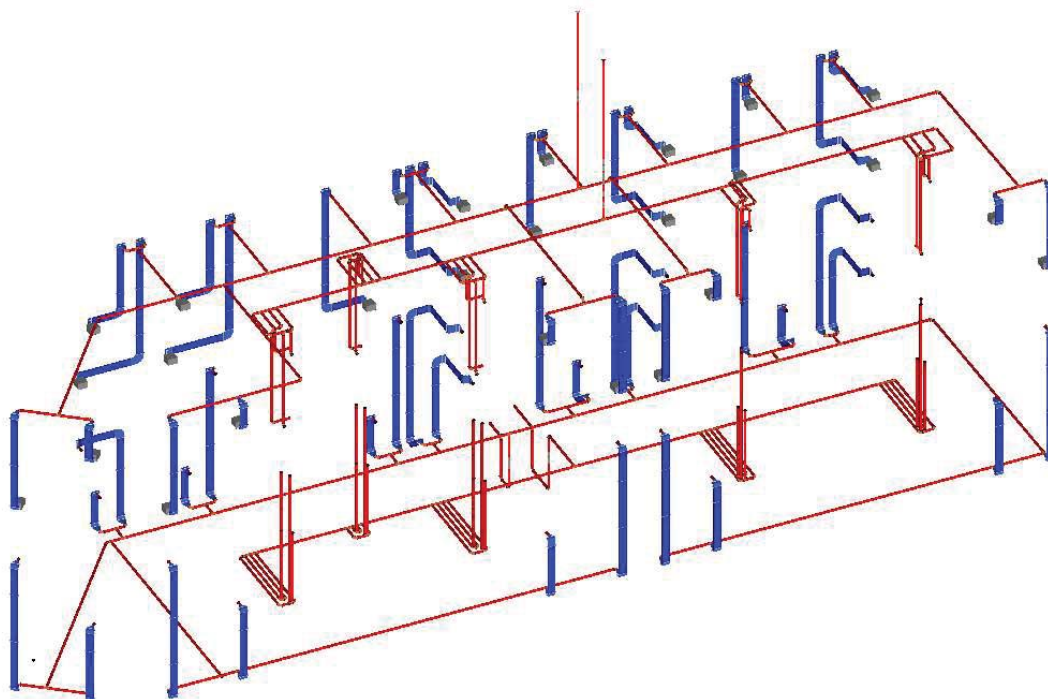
Zu- und Abluftkanalnetz des zentralen Lüftungssystems mit zwei Lüftungsanlagen im Keller und auf dem Dachboden, fassadenintegrierte Flachkanäle in Blau, kreisrunde Lüftungsrohre in Rot
